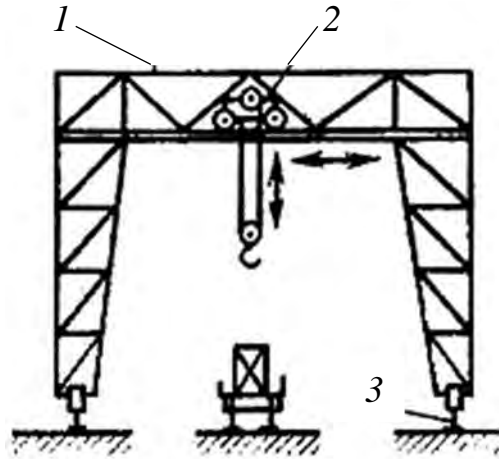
Схема козловой крана: 1 – металлоконструкция крана; 2 – механизм подъема и перемещения тележки; 3 – рельсовый путь
